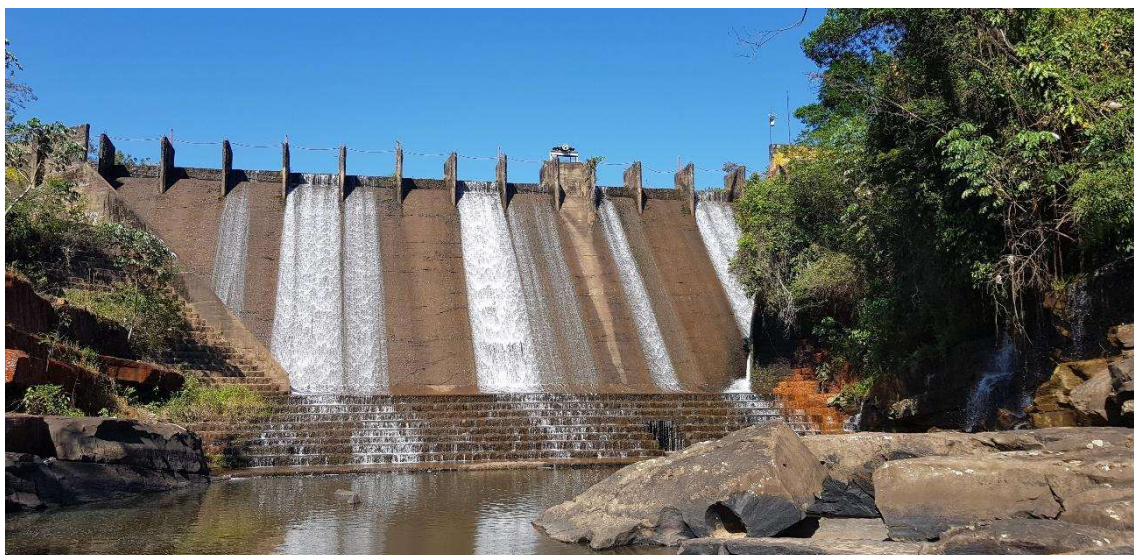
Vertedouro e descarregador de fundo (inoperante).
